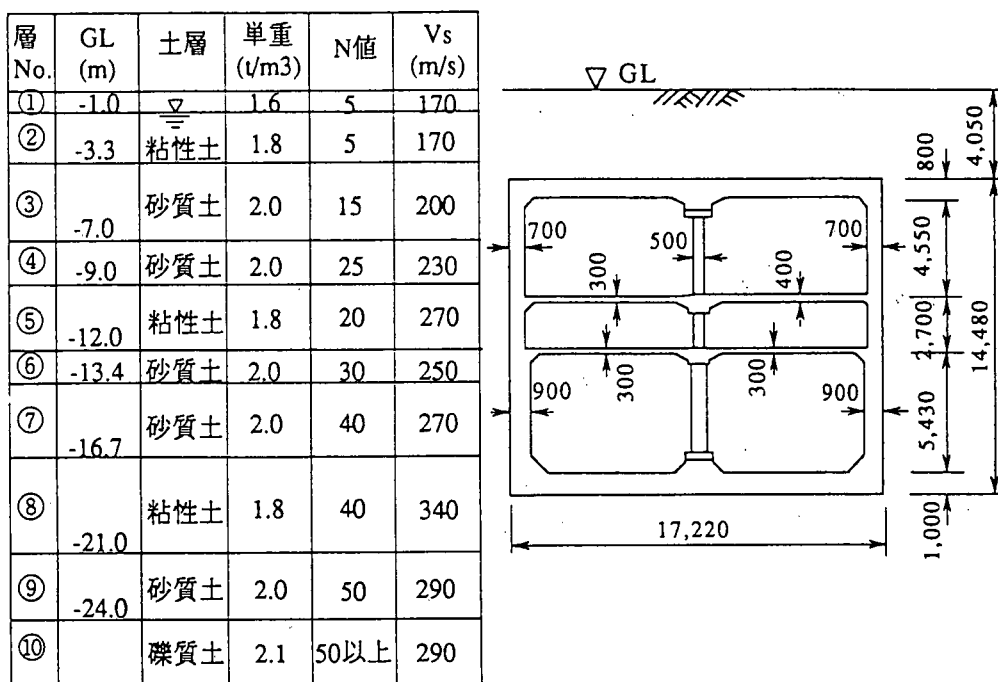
地盤物性値と構造物諸元¹⁸⁾
